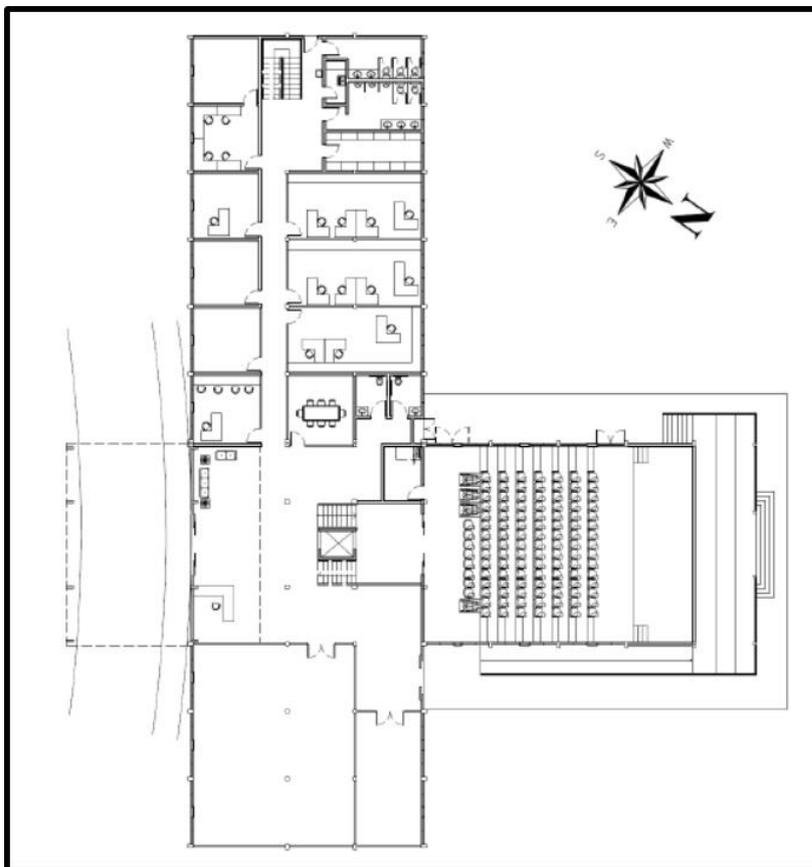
PLANTA BAIXA DO 1º PAVIMENTO (“T”) DO 5º RCC
